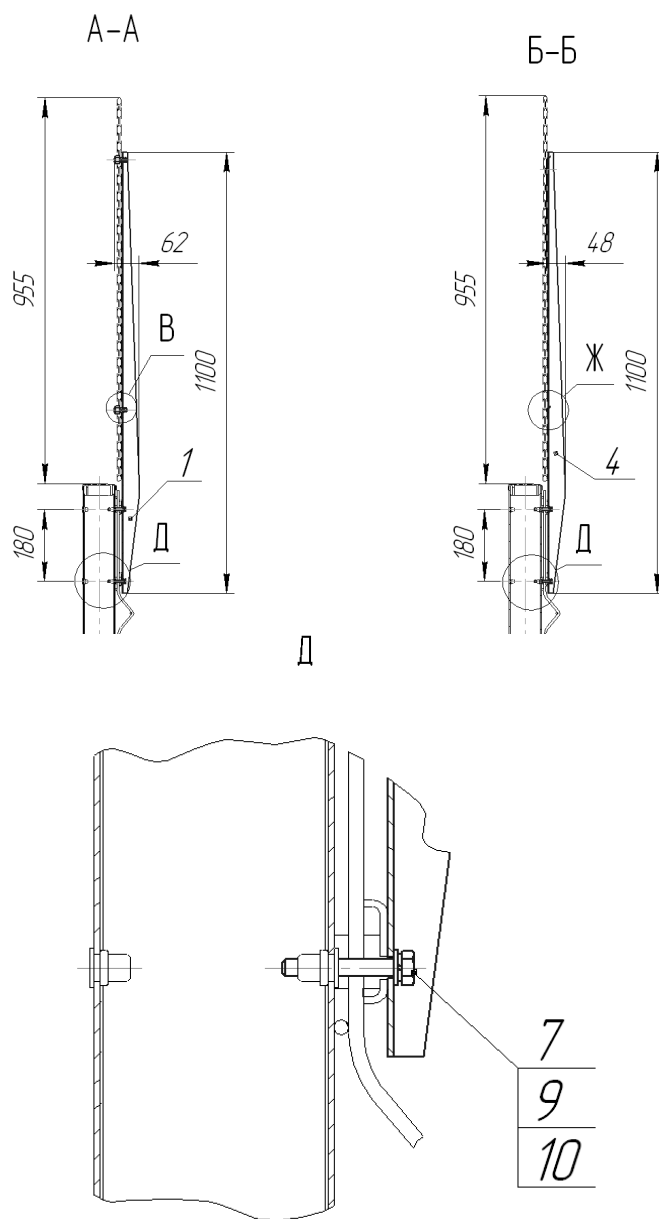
Разрезы А-А, Б-Б, детальный вид Д
